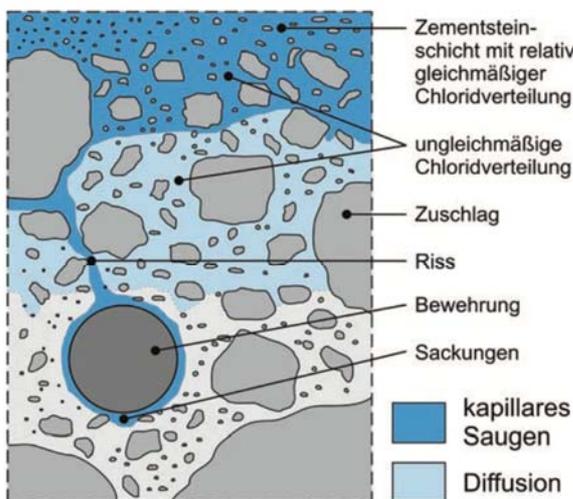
Verteilung der eingedrungenen Chloride im Beton
